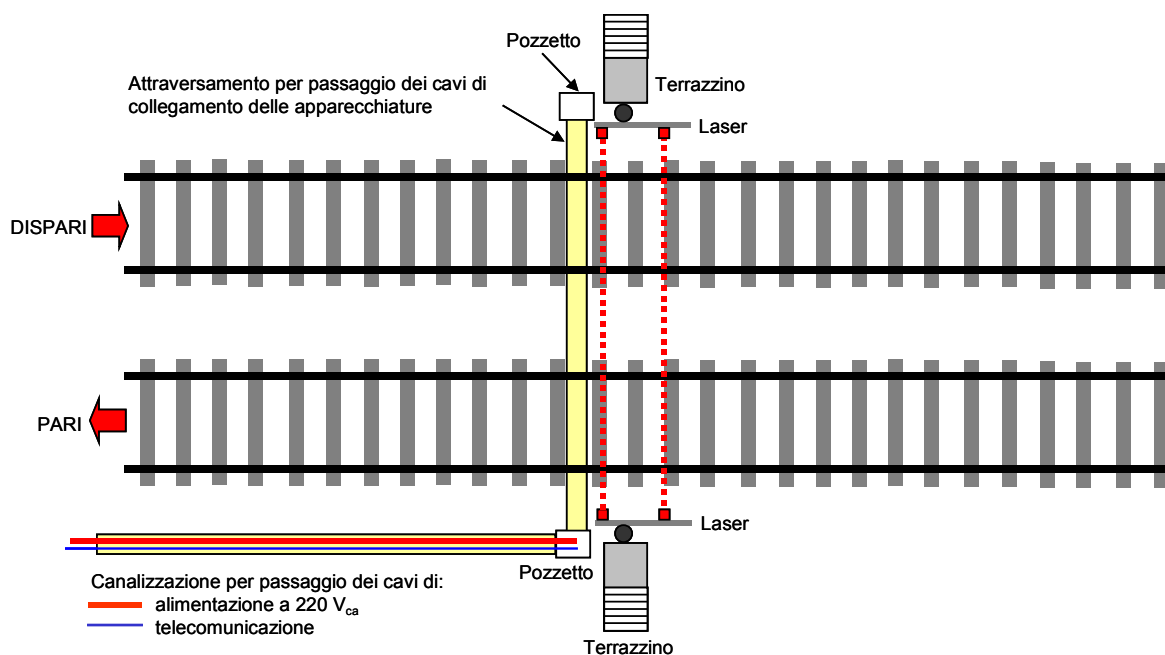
Vista in pianta delle predisposizioni di impianto per un PRR
